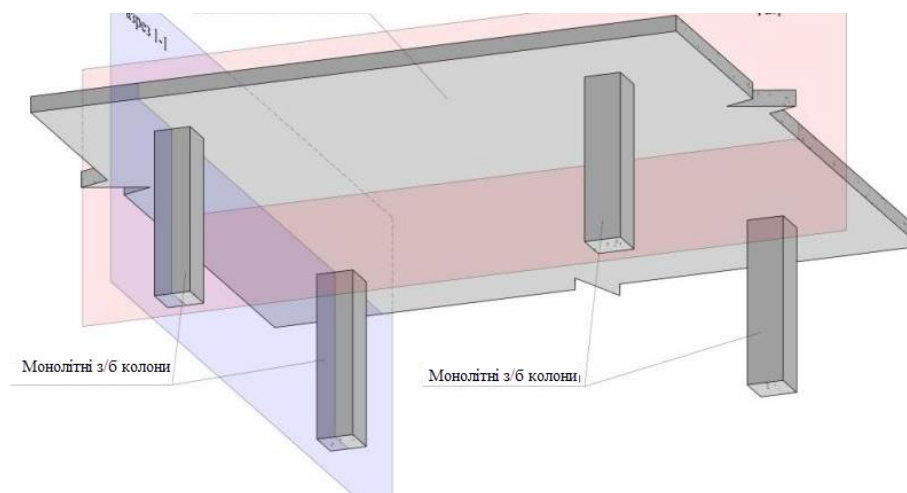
Безбалкове монолітне залізобетонне перекриття
